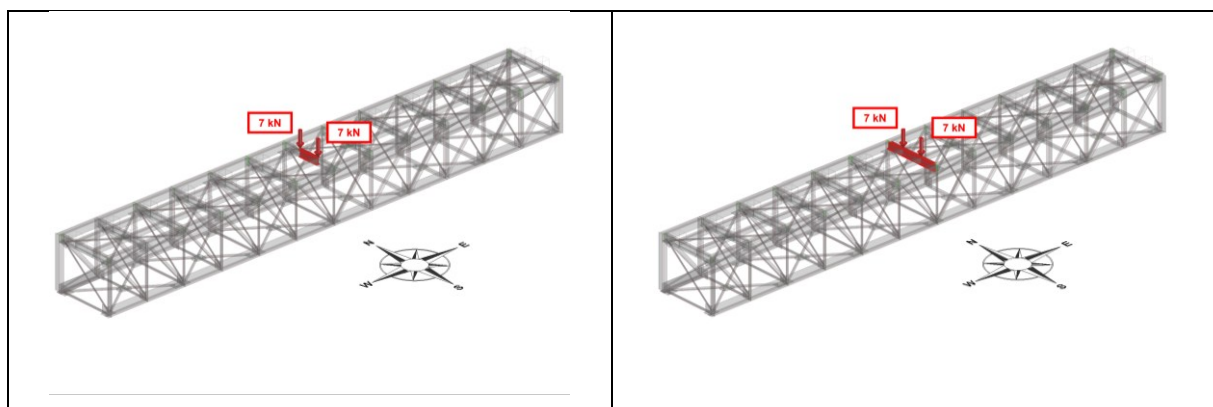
Configuración de cargas y definición del elemento eliminado en el escenario de fallo, parcial y total, de la viga transversal superior central
